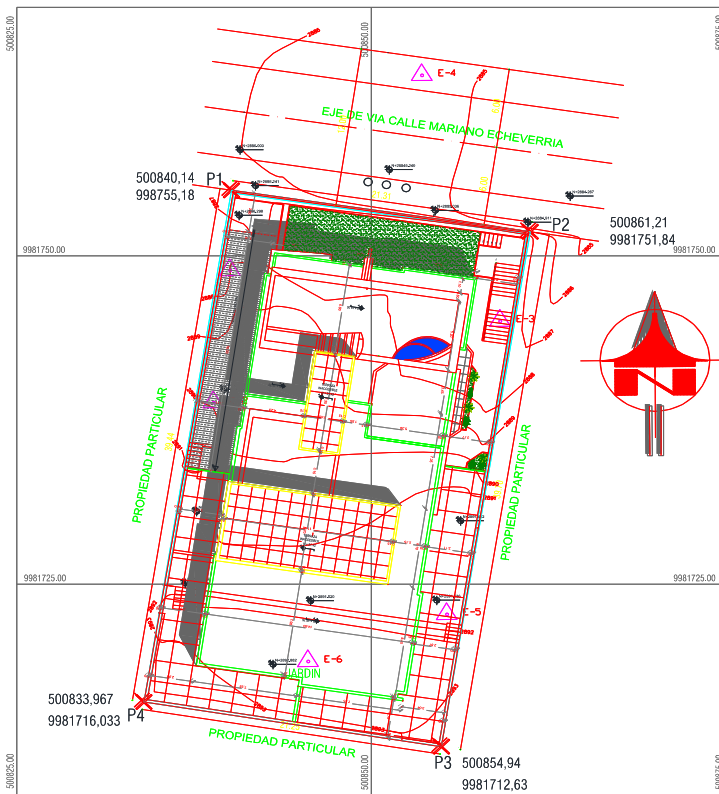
6 Implantación Arquitectónica del Edificio Leganz Plaza
